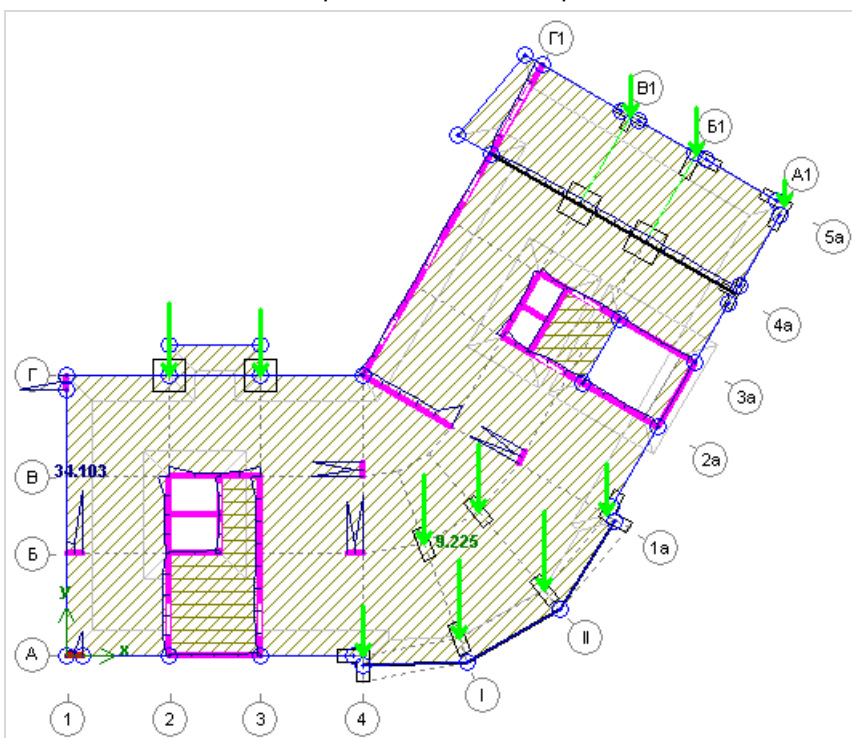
Плита перекрытия типового этажа с результатами расчета этажа
